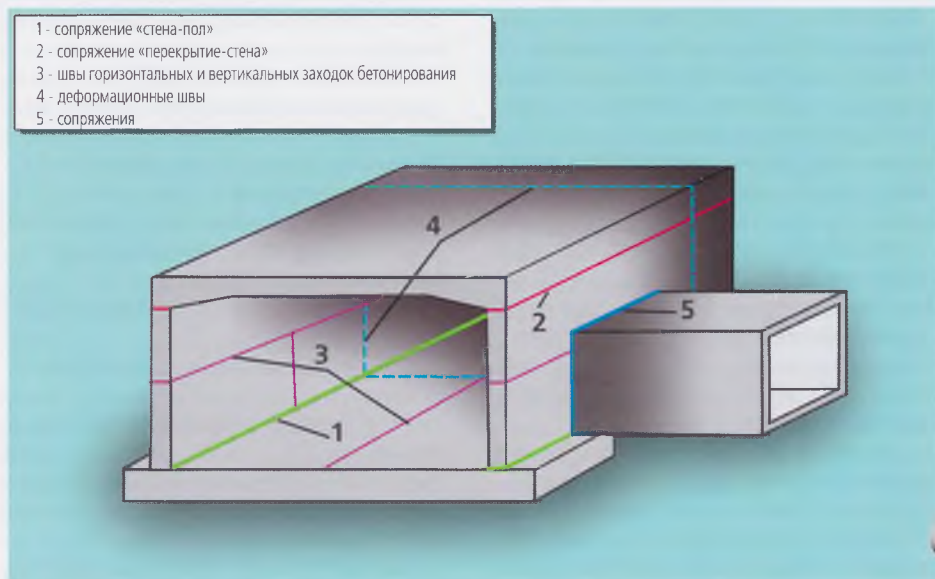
Наиболее уязвимые места в железобетонных конструкциях тоннелей, сооруженных открытым способом
